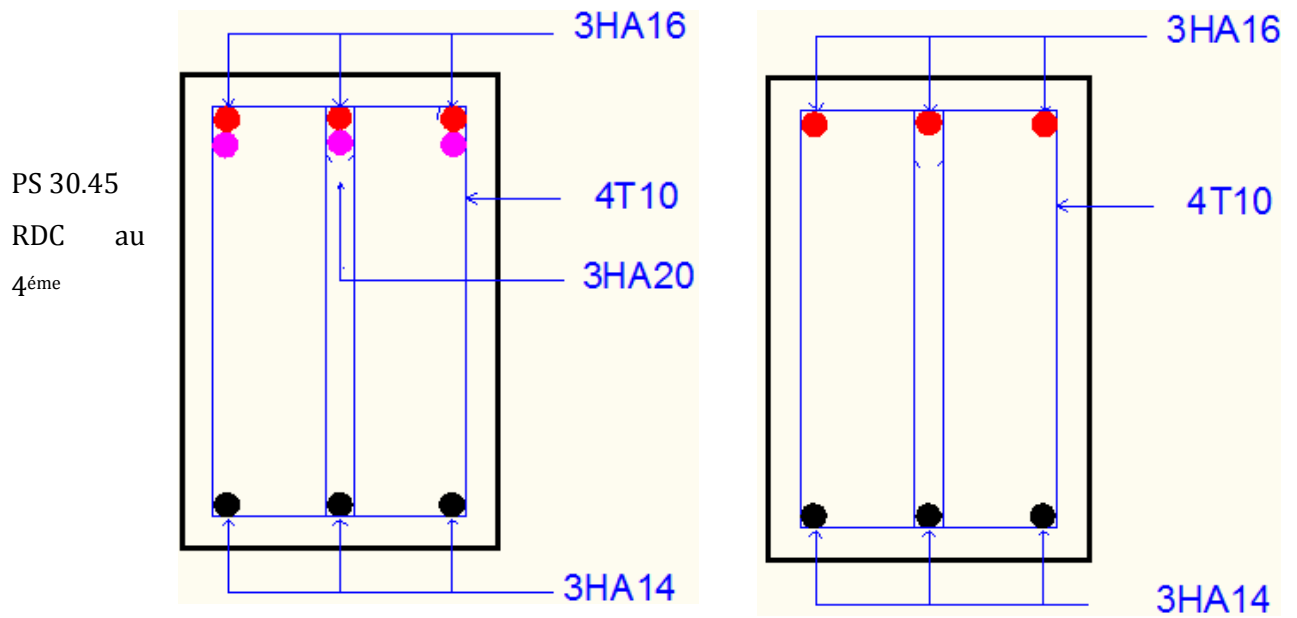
Section de ferrailage des poutres secondaire RDC au 4ème.
